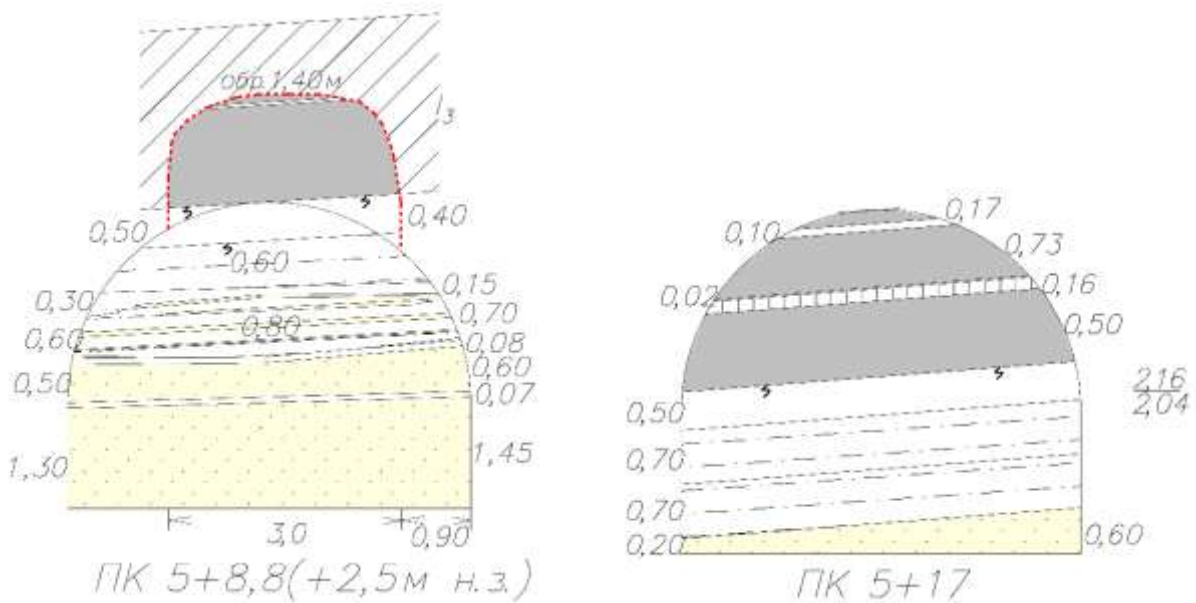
Сечение вскрывающей выработки в момент вскрытия пласта
